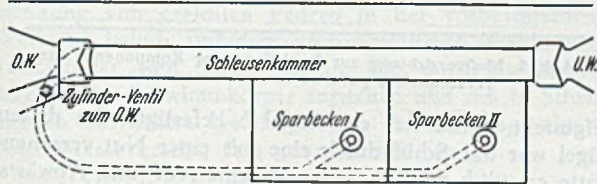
Allgemeine Grundrissanordnung des Modells 1:24.
